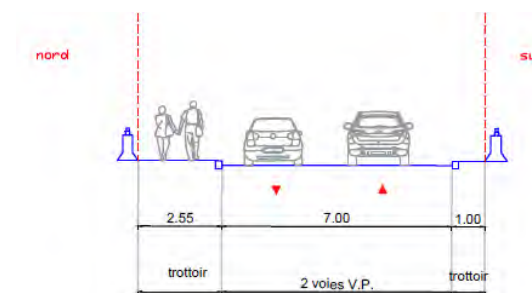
Coupe en travers de l'ouvrage OA4 franchissant le boulevard du Parc
